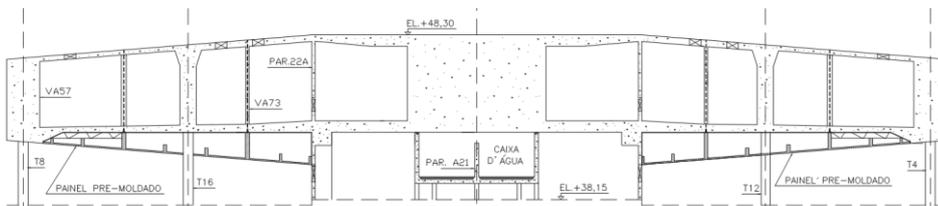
Corte AA da estrela estrutural. Fonte: Arquivo da PGR.
